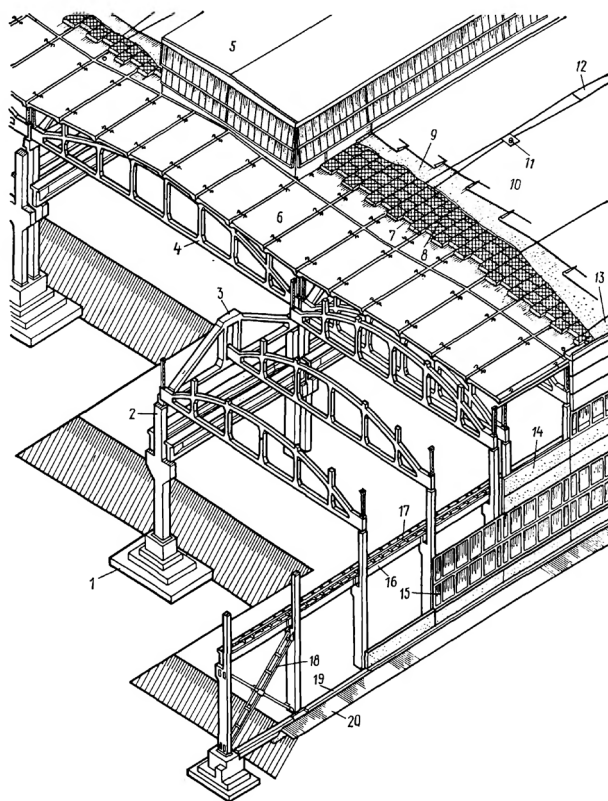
Конструктивные элементы одноэтажного здания с железобетонным каркасом:
